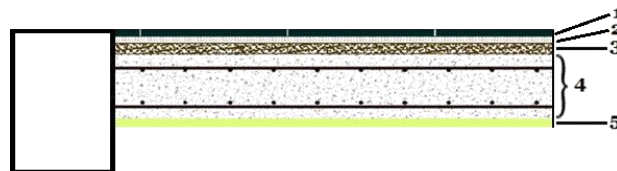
Coupe transversale d'un balcon à dalle pleine étage courant.
